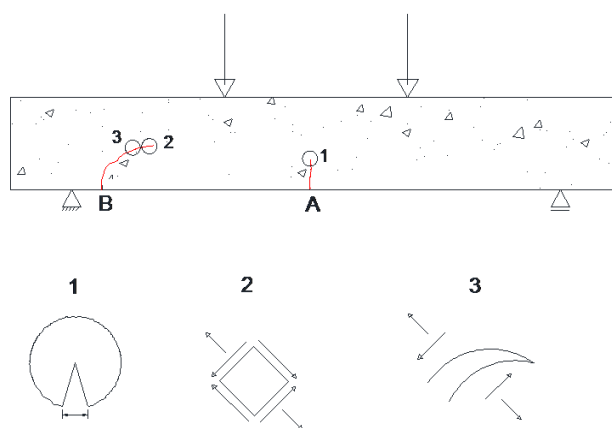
Ensaio de flexão sob quatro pontos de carga de uma viga de betão armado.
